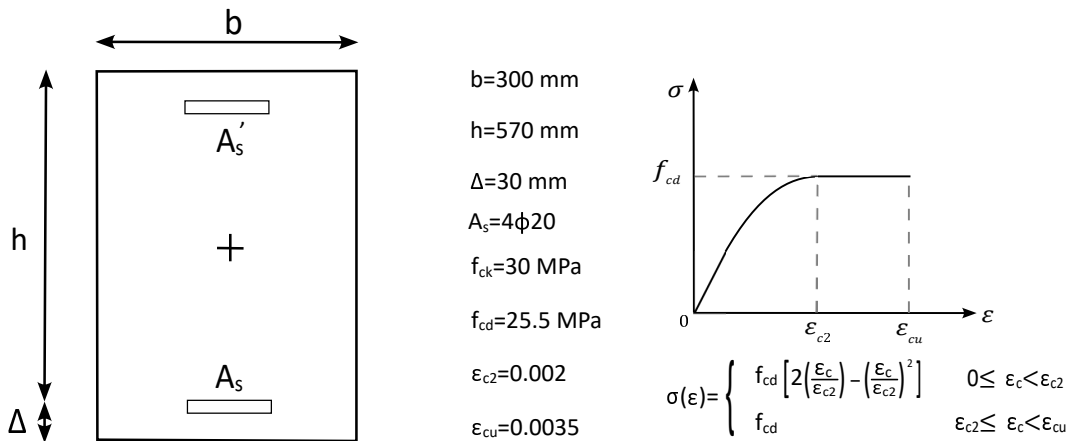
Sezione rettangolare in c.a. soggetta a flessione, caratteristiche geometriche e meccaniche
